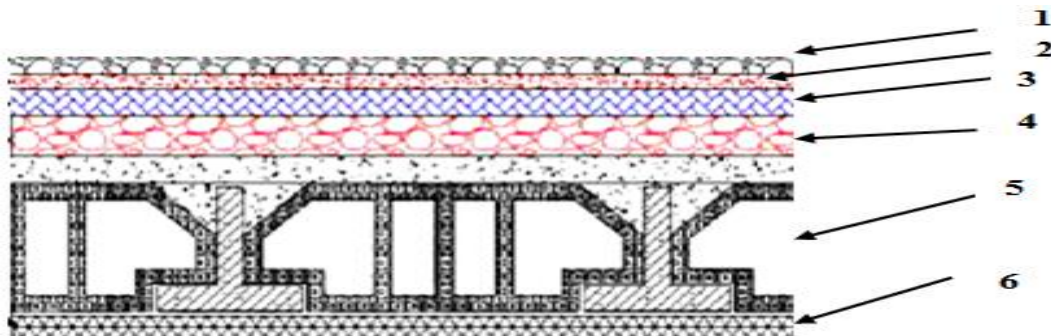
coupe d'un plancher à corps creux du plancher terrasse
